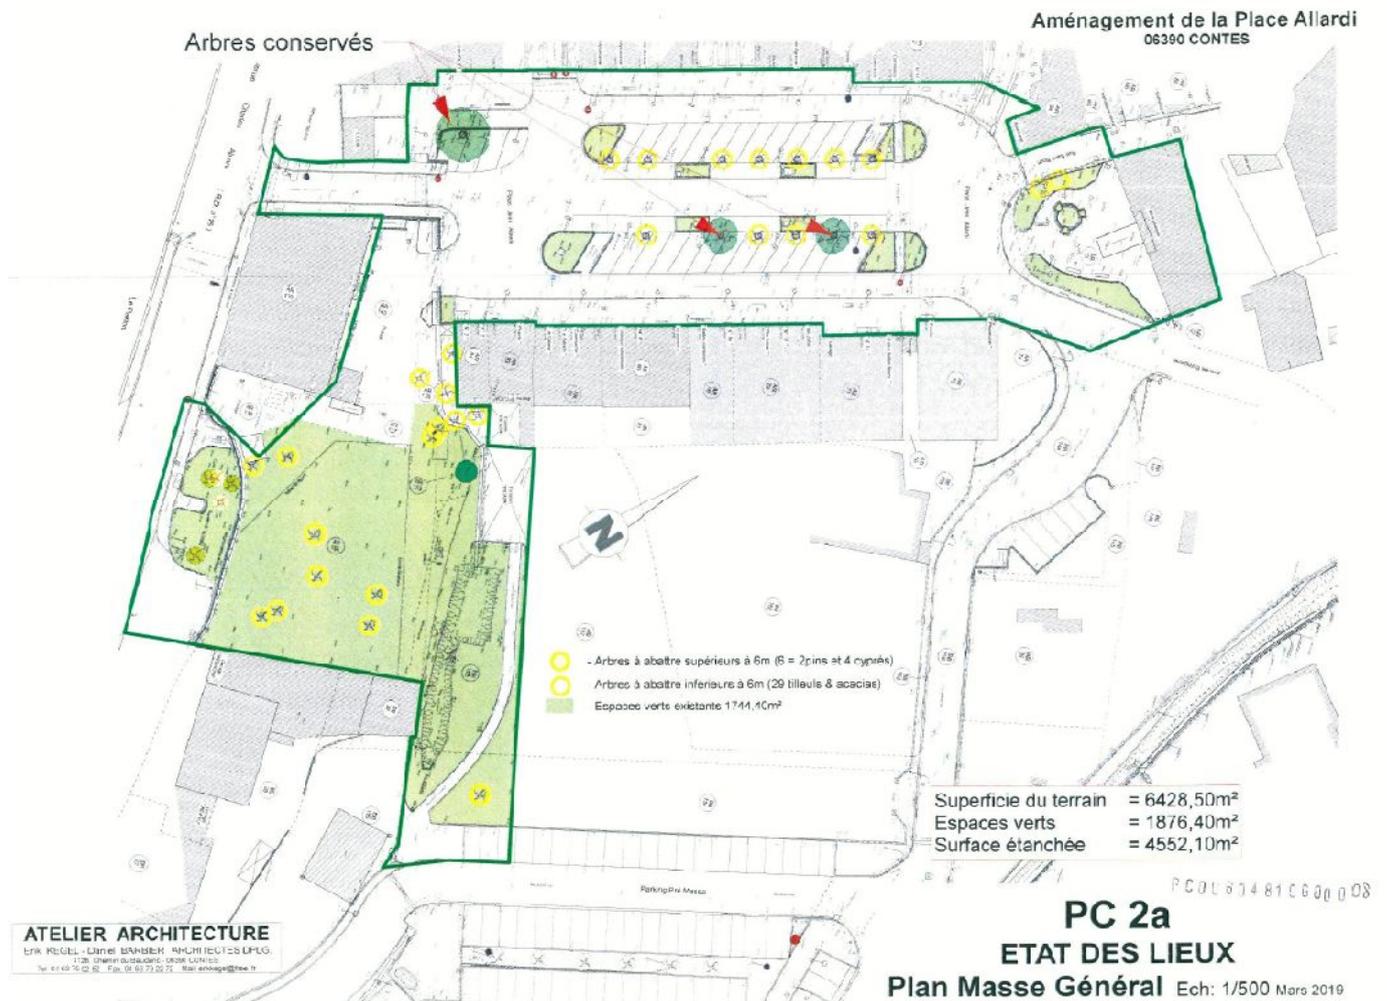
Etat des lieux - Plan masse de la situation existante (Source : Mairie de Contes)
